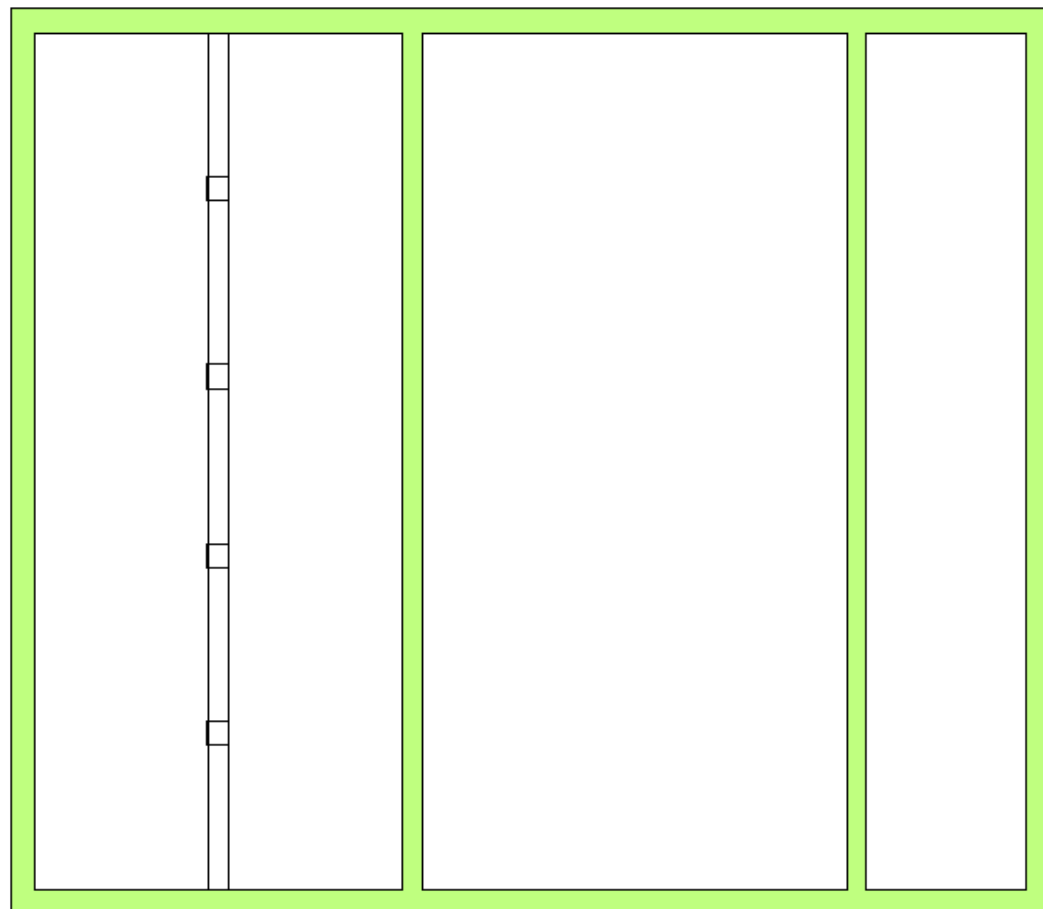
Detalle esquemático de los muros de carga (Fuente propia)
